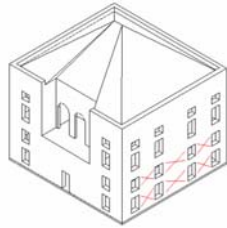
Schadenstyp P5: Schubversagen der Aussenwände – Vertikale Elemente
